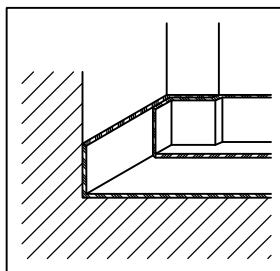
В 6: Ущільнювач з будівельної мембрани на нижньому з'єднанні вікна
